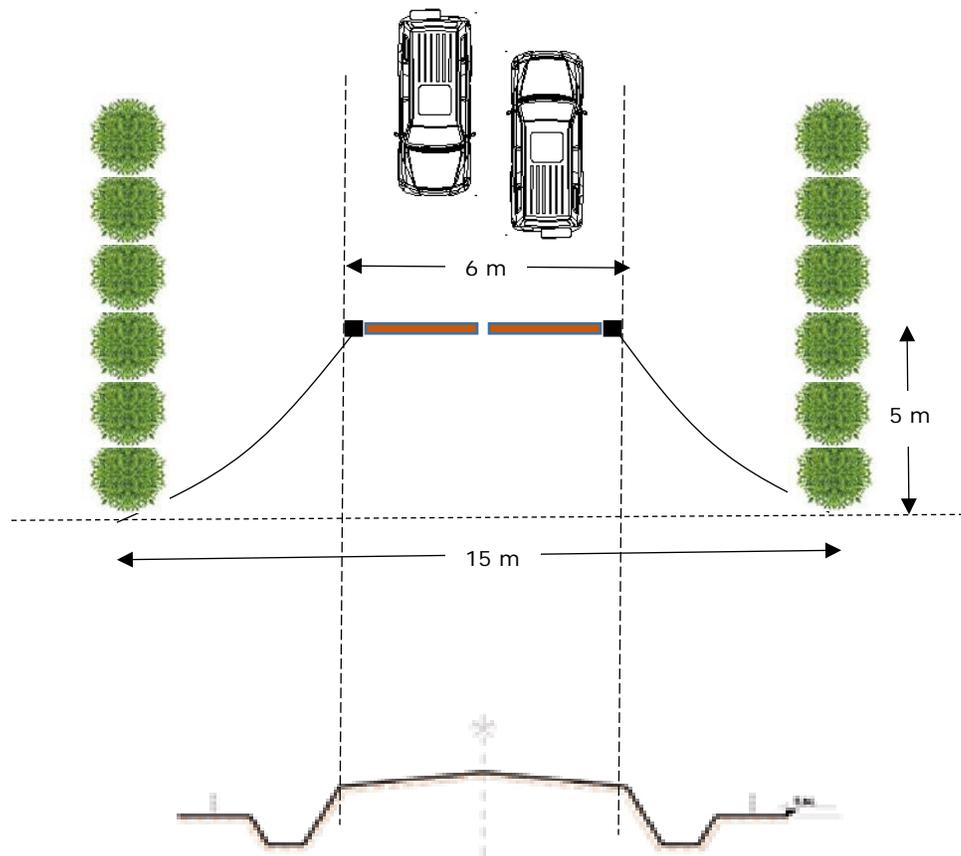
Superior: Vista en planta de acceso en "embudo". Inferior: corte de callejón
